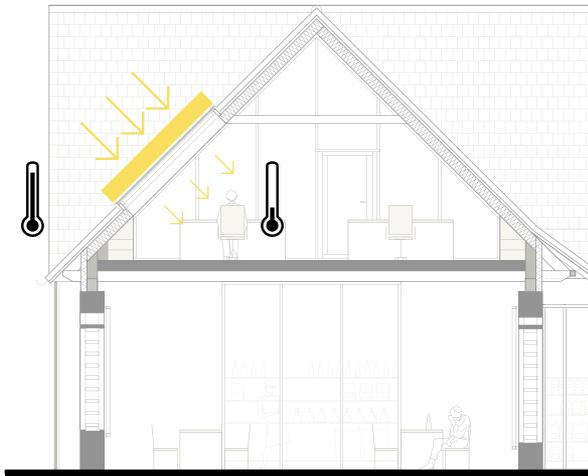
Photovoltaik-Schiebeläden am Dach schützen vor sommerlicher Erwärmung
